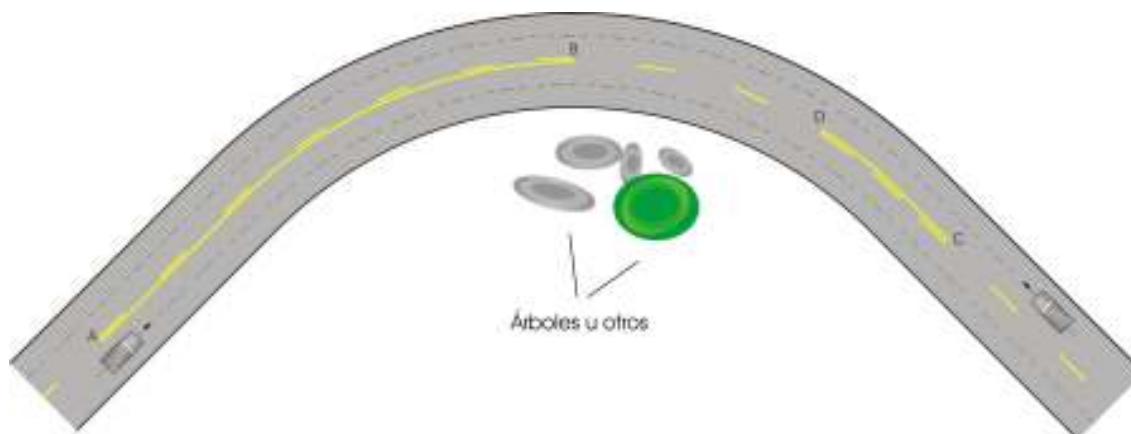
EJEMPLO DE NO ADELANTAR, RESTRICCIÓN EN PLANTA
